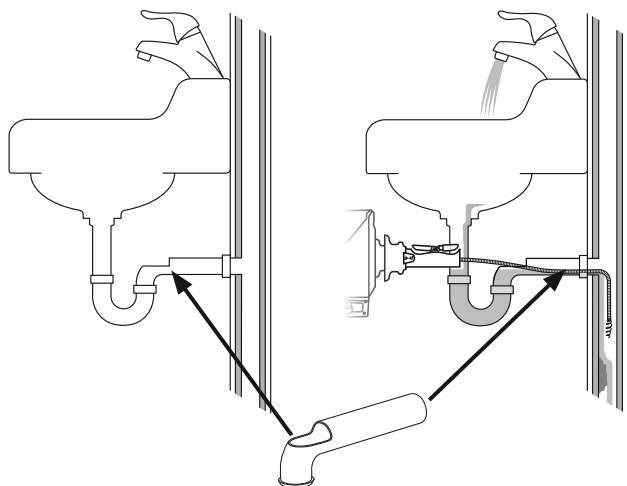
Installazione del tubo a parete (accessorio disponibile)
